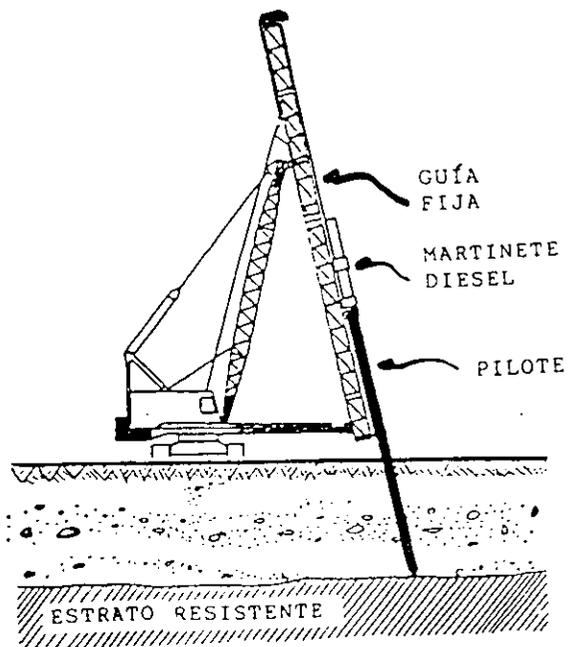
PILOTE HINCADO INCLINADO.
